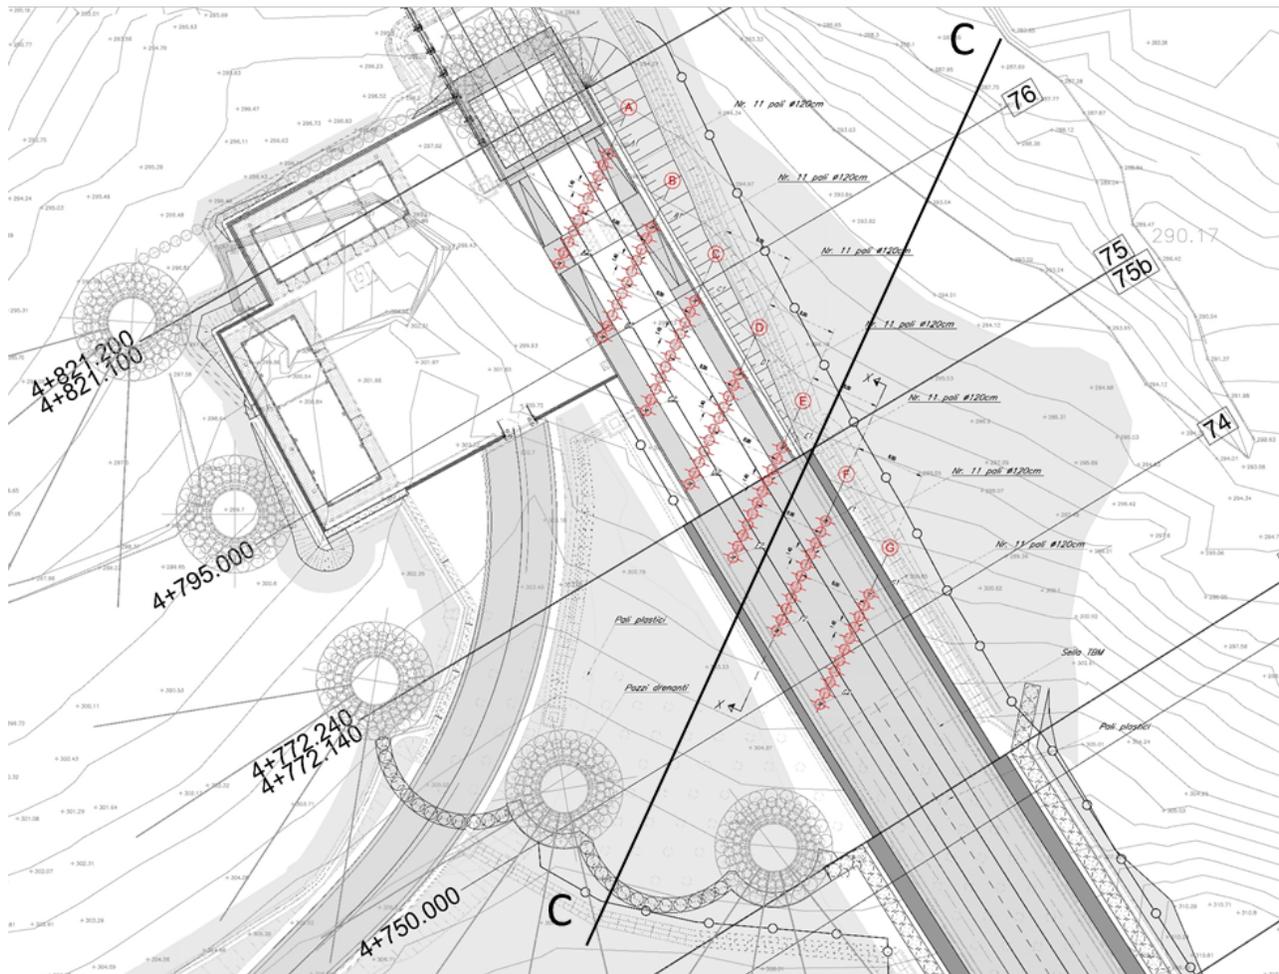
Vista in pianta dell'opera e posizione della sezione di calcolo (CC) (Doc. Rif. [19])
